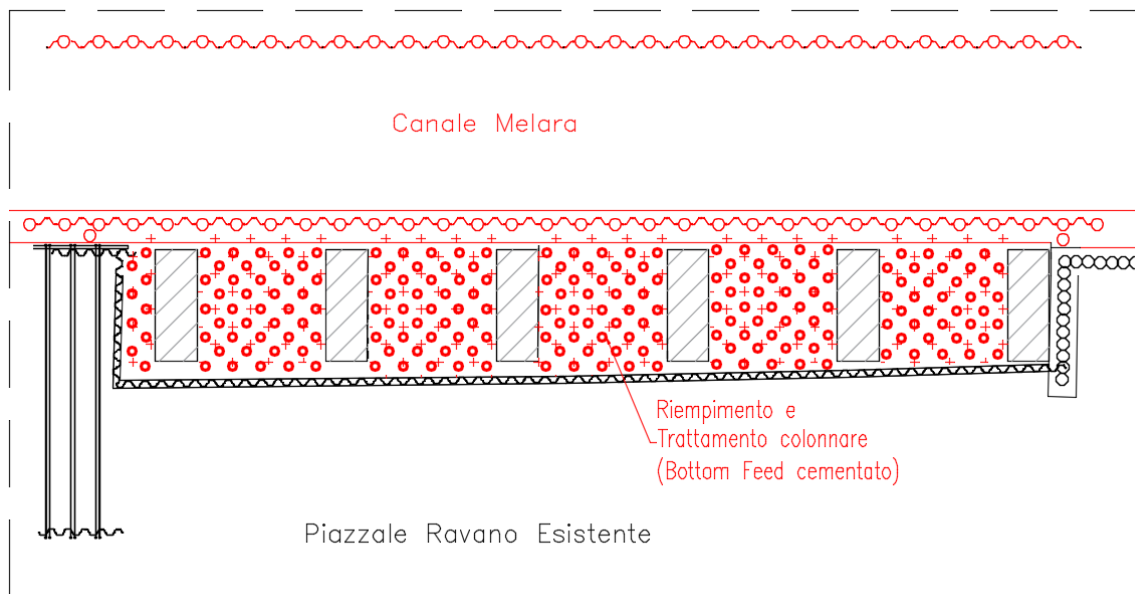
planimetria con indicati i plinti di fondazione del vecchio pontile
